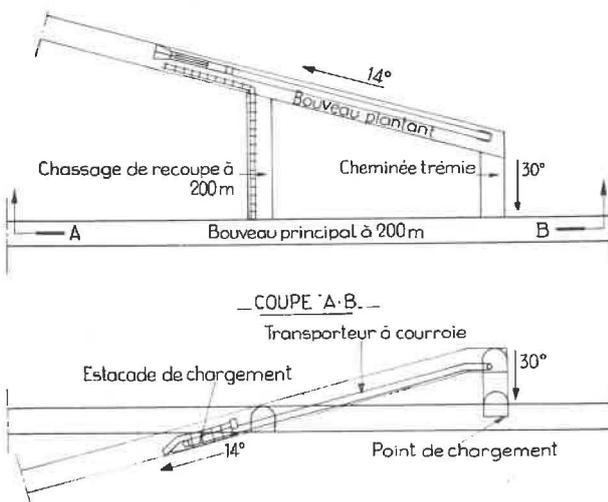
Chargement par scraper d'un bouveau plantant. Siège n° 6. Bouveau plantant sous 200m. Au-dessus : vue en plan. En dessous : coupe AB.
